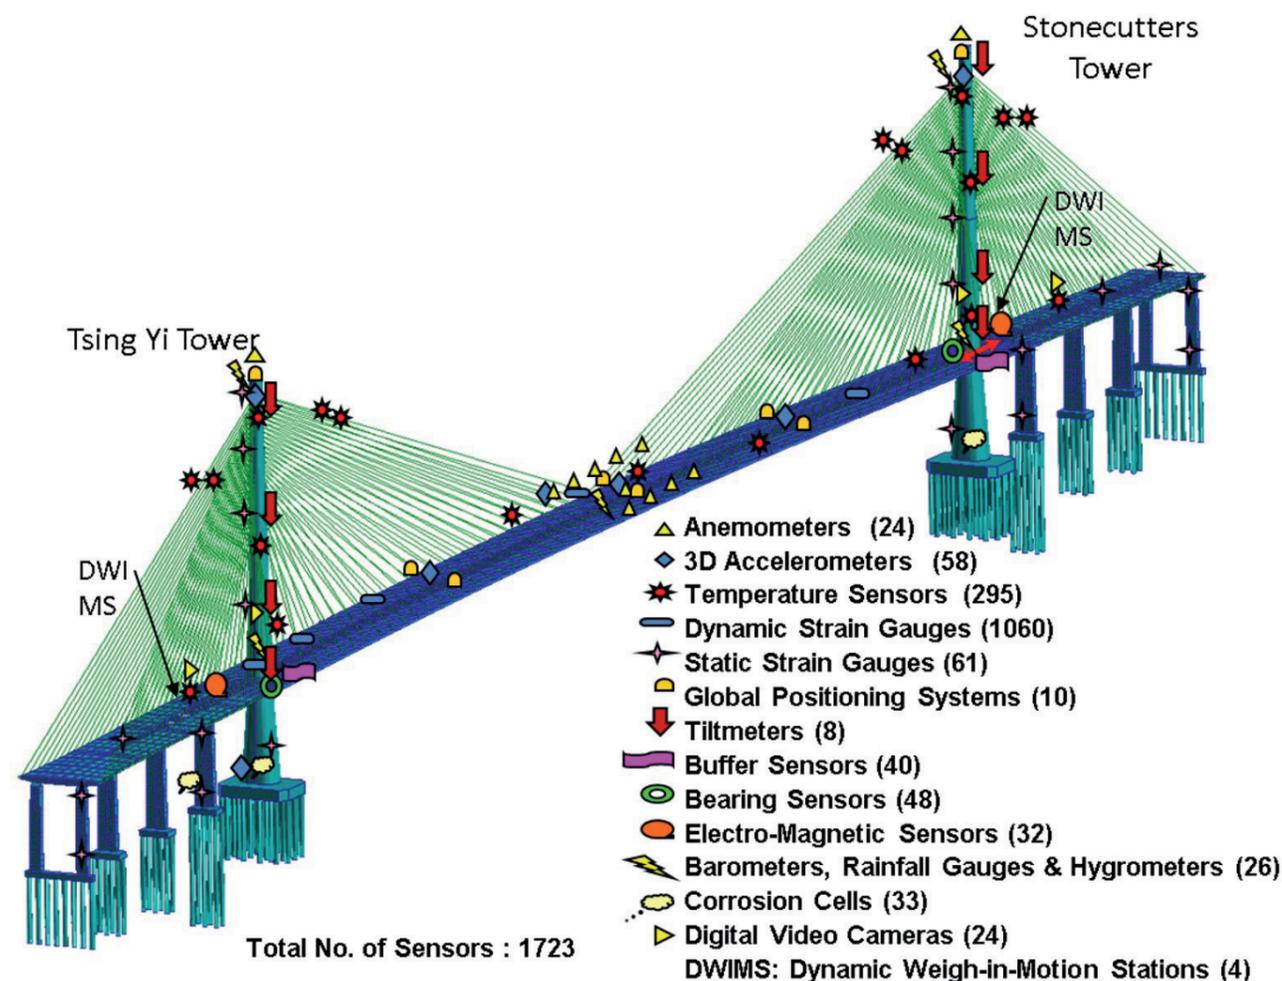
Layout del Sistema di sensori sullo Stonecutters Bridge
